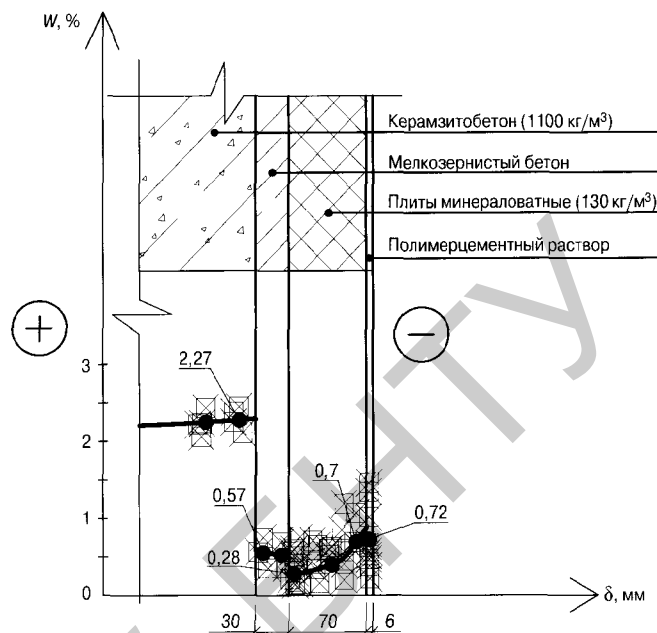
Распределение массовой влажности по толще наружной стены из стеновых панелей с дополнительной теплоизоляцией штукатурной системой
